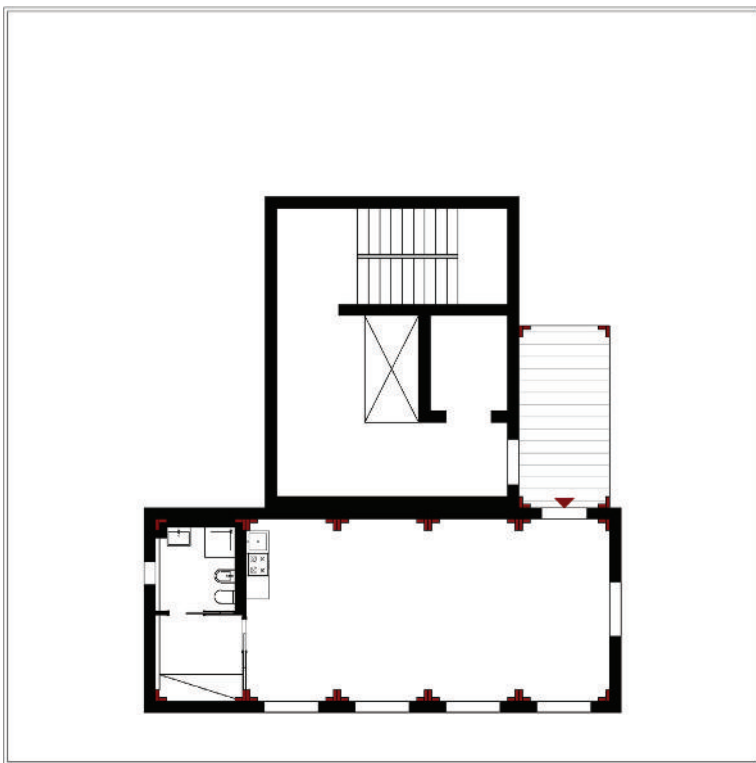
\_ Ipotesi di aggiunta in copertura su un edificio a torre \_ Planimetria \_ Scala 1:200
